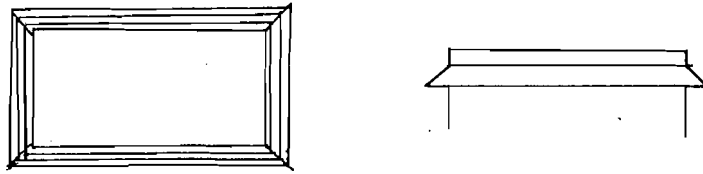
Pelat Lantai yang Direkomendasikan
